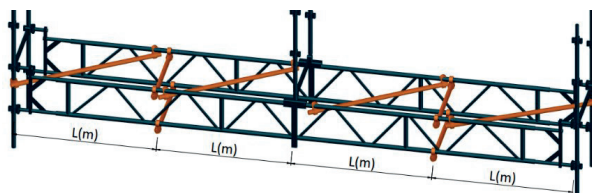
Laçage sur poutre alu (longueur L à déterminer suivant le moment admissible des poutres)
